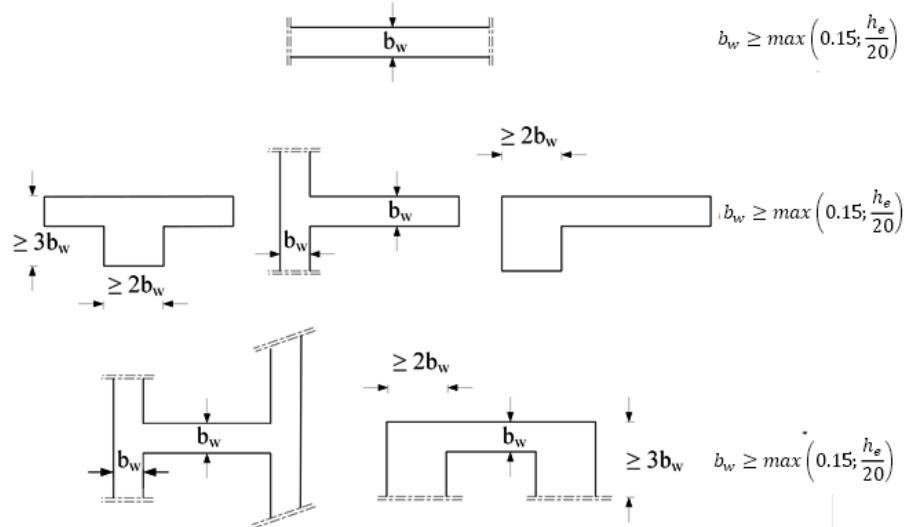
Epaisseur minimum en fonction des différentes configurations
